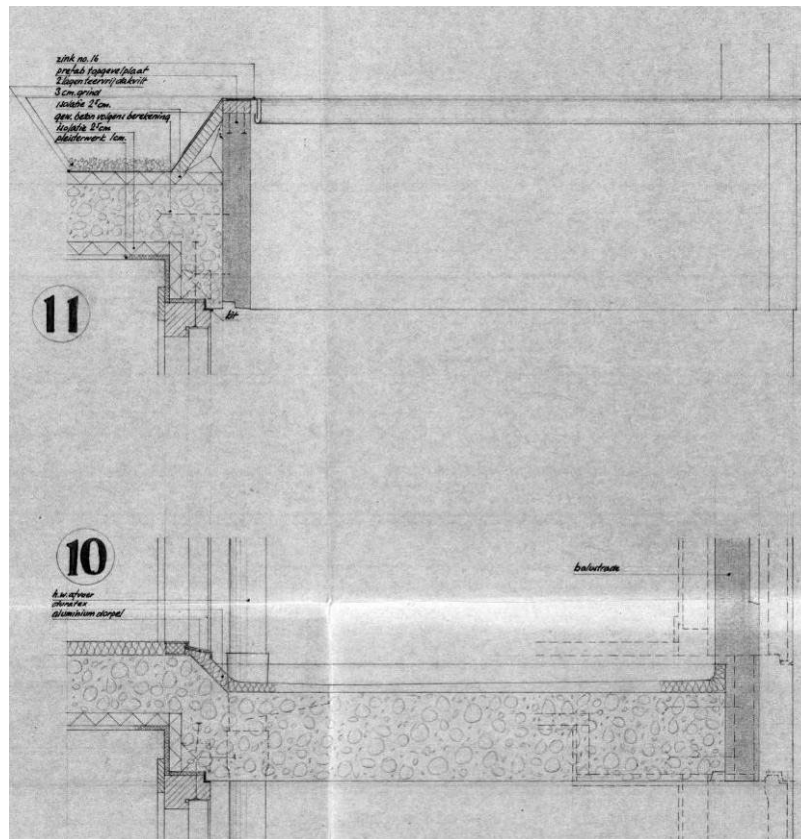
Blok T (Toren) constructie, verticale details van de dakrand en de brede loggia's, september 1958 (Bowoto 4839-01).
